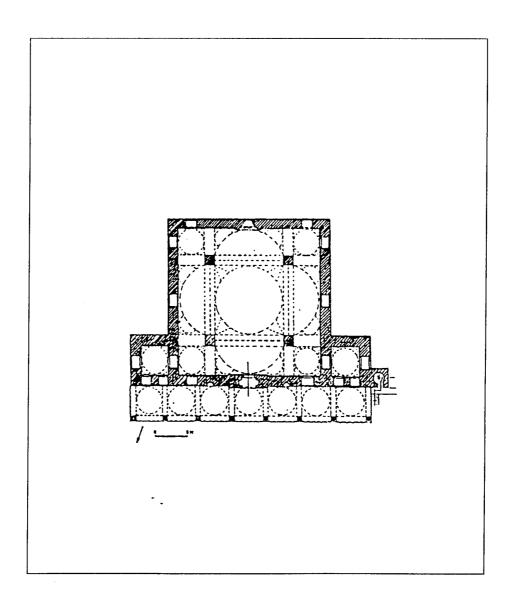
مسقط أفقي لمسجد چلبي سلطان محمد في ديموتيقا (عن : اصلان ابا)
